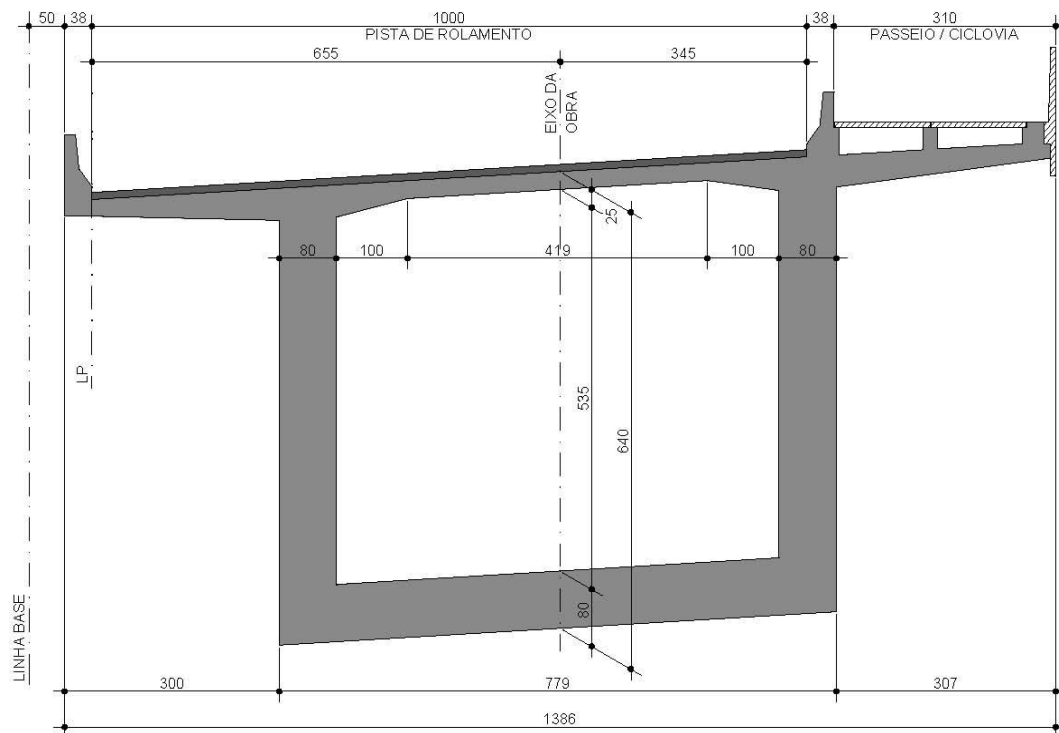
Seção transversal da OAE – próximo aos pilares.
